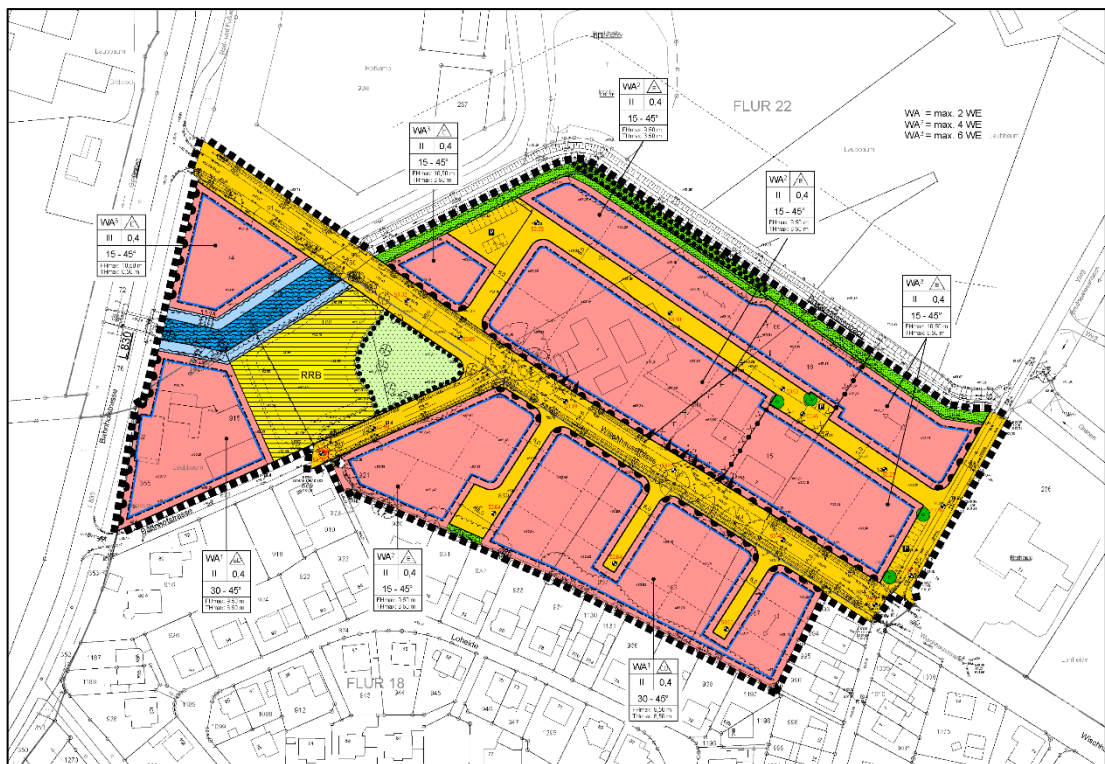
Bebauungsplan mit Lage des Plangebietes
